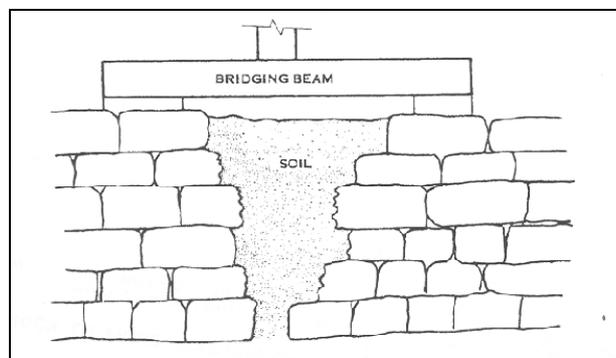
Illustration de l'enjambement d'un fontis par une poutre (Sowers, 1984).
